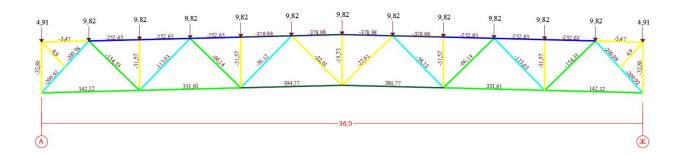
Расчетная схема с внутренними усилиями и приложением нагрузки (снеговая)
